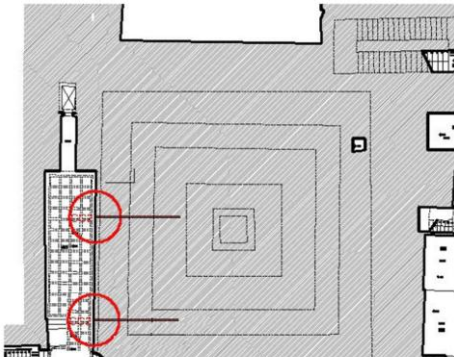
Planimetria con indicazione dei due carotaggi CC2 (al centro) e CC3 (in basso) eseguiti sul muro meridionale al pian terreno della Torre Pisana, alle quote di ca. 37,85 e 37,65 m s.l.m.
